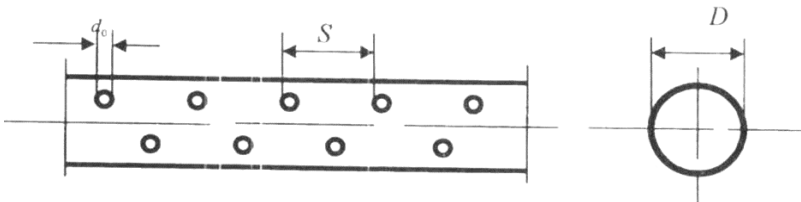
Пластмассовая труба с круглой перфорацией без фильтра
